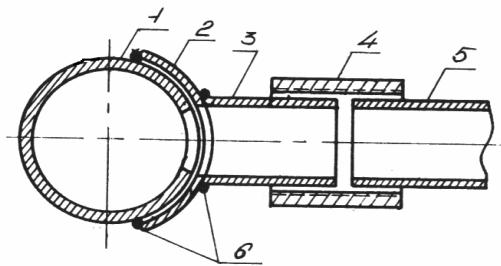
Схема приварки штуцера с седёлкой к газопроводу: 1 – газопровод; 2 – седёлка; 3 – штуцер; 4 – муфта; 5 – ввод; 6 – место сварки
